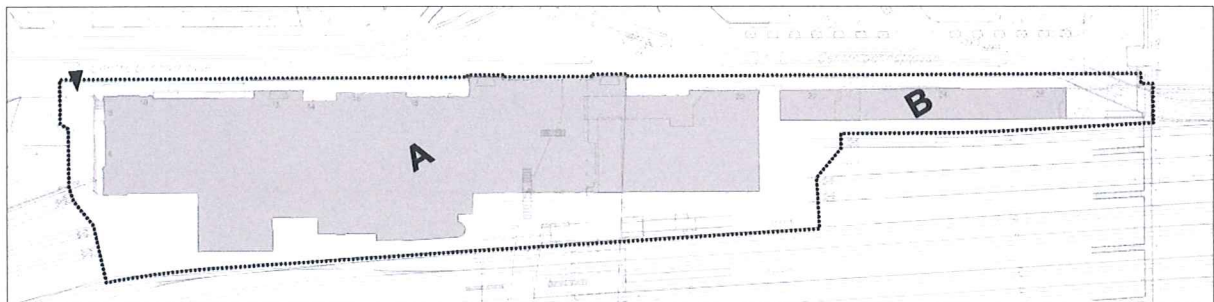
Bebauungsplan, Plan Nr. 13'367. (Kein Massstab, nicht genordet)
